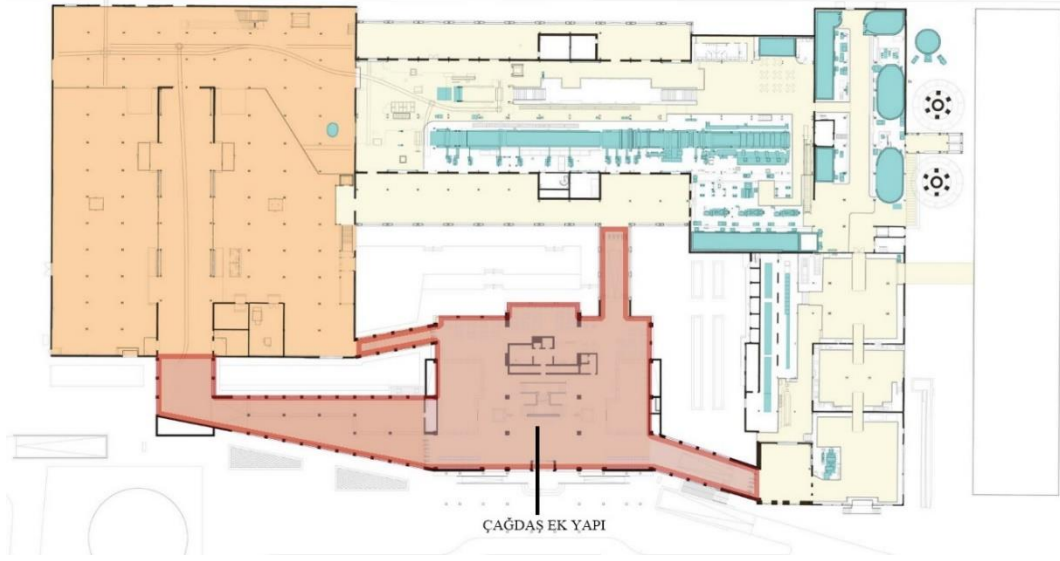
Seka Kağıt Fabrikası Mevcut Yapı +3.50 Kot Planı
